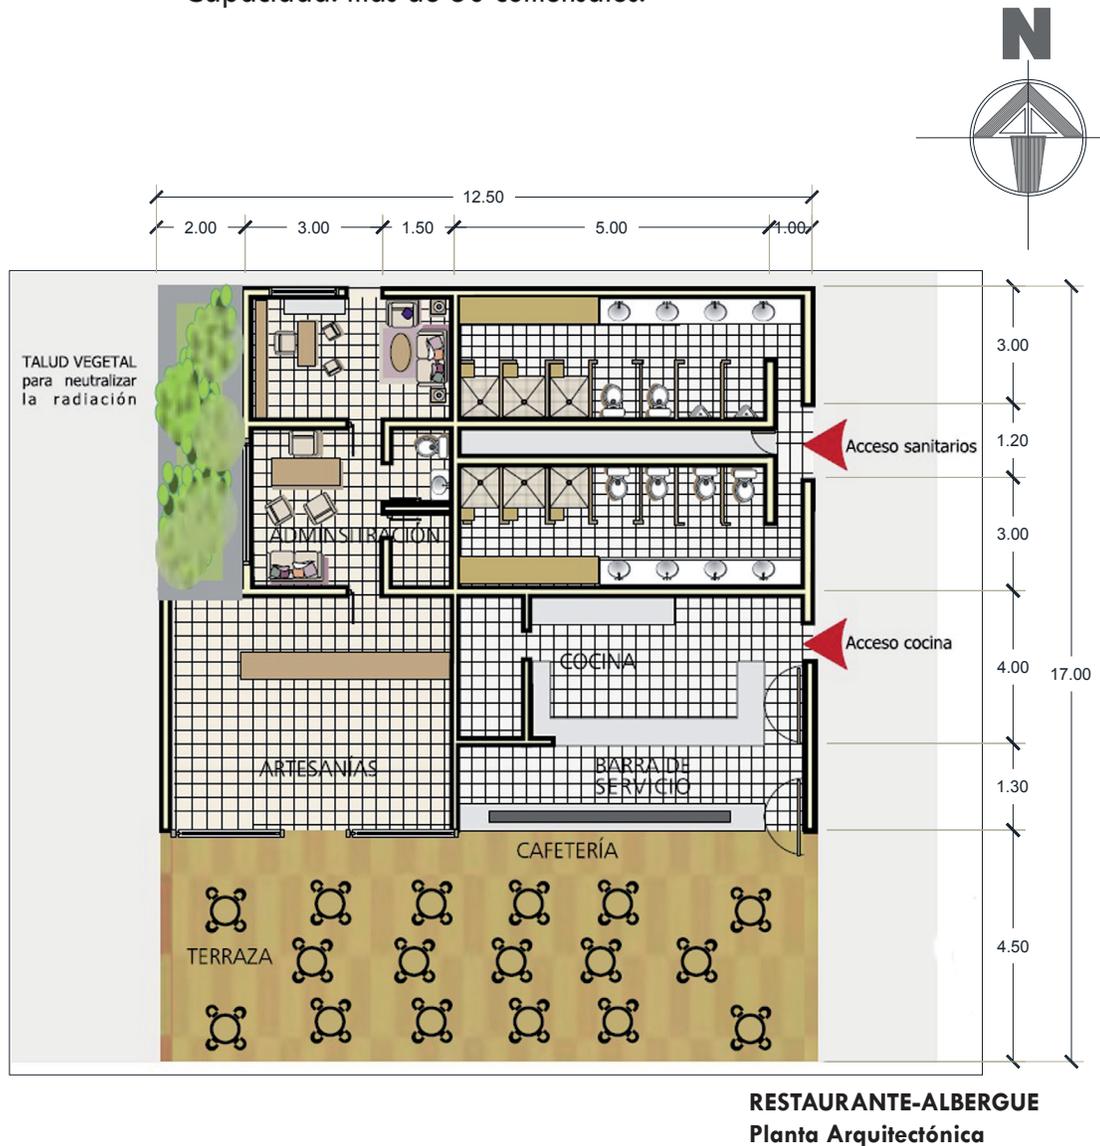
| Ejemplo de una planta arquitectónica de un restaurante-albergue para un complejo ecoturístico.³⁷
